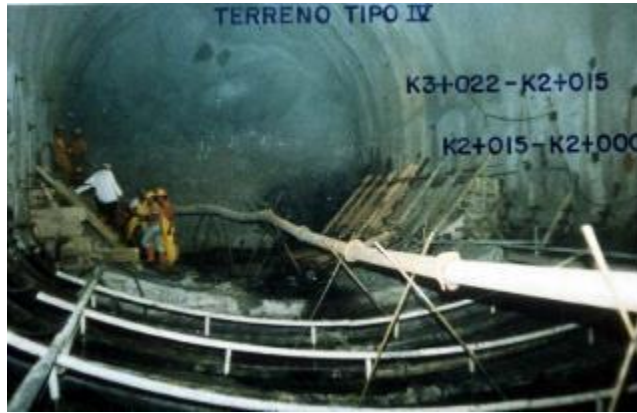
Zona de empujes en terreno tipo IV. Túnel de Fuga (Proyecto Guavio).
